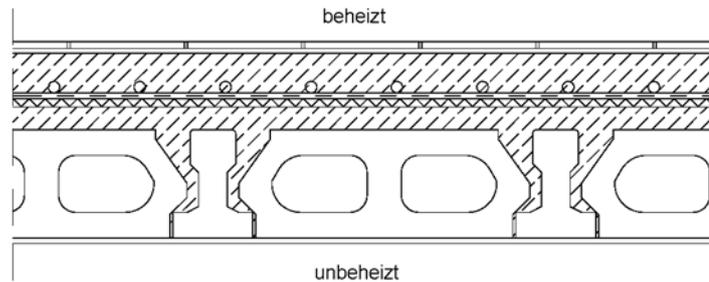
Rippendecke mit dem Fußbodenaufbau
